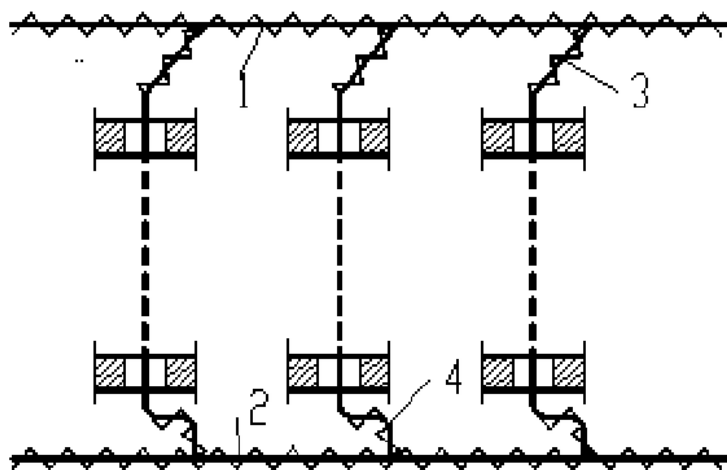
Теплоизоляция трубопроводов систем отопления:
